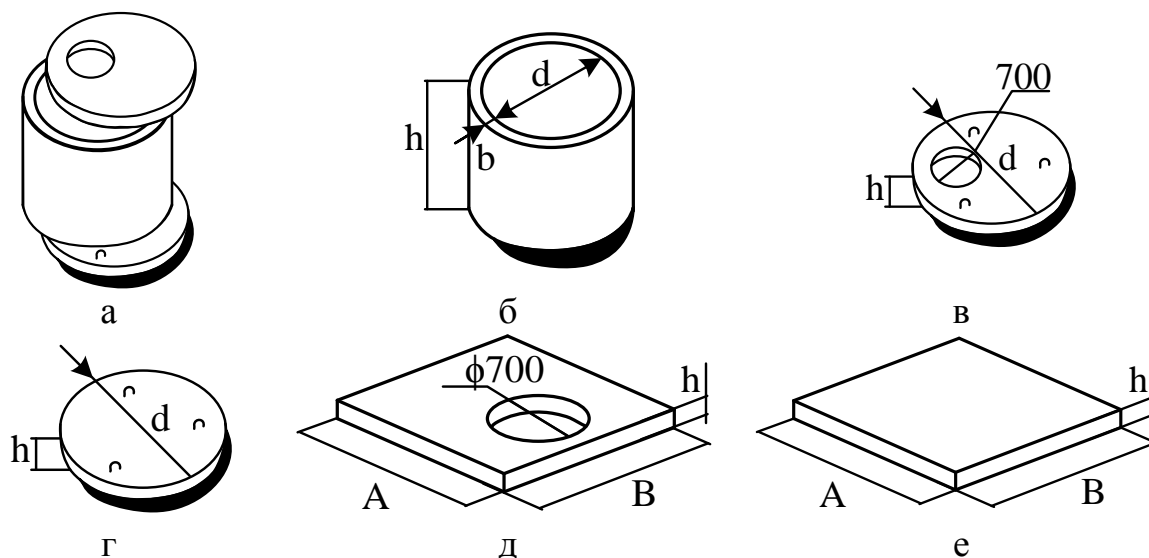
Изделия круглых колодцев: а – общий вид; б – кольца; в – плиты перекрытий (круглые); г – плиты днища (круглые); д – плиты перекрытий; е – плиты днища
